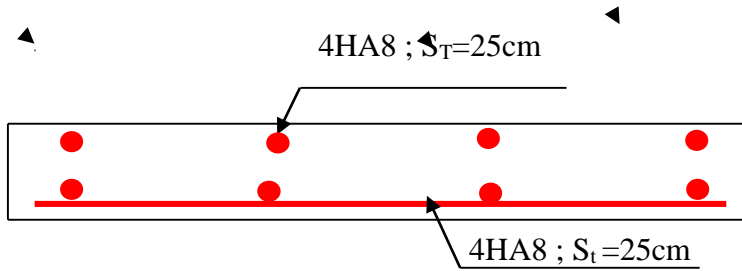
Schéma de ferrailage de la dalle sur 4 appuis
